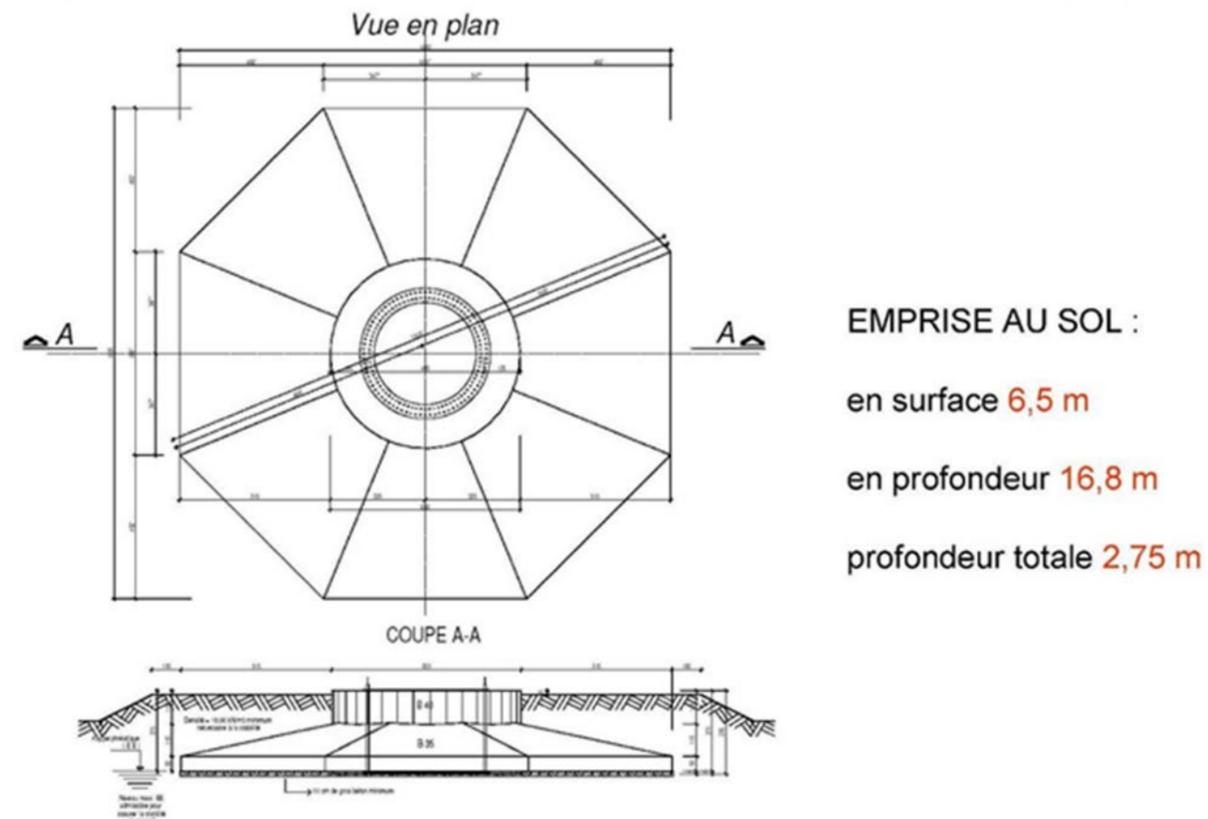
EXEMPLE DE FONDATION - (SOURCE JPEE)
